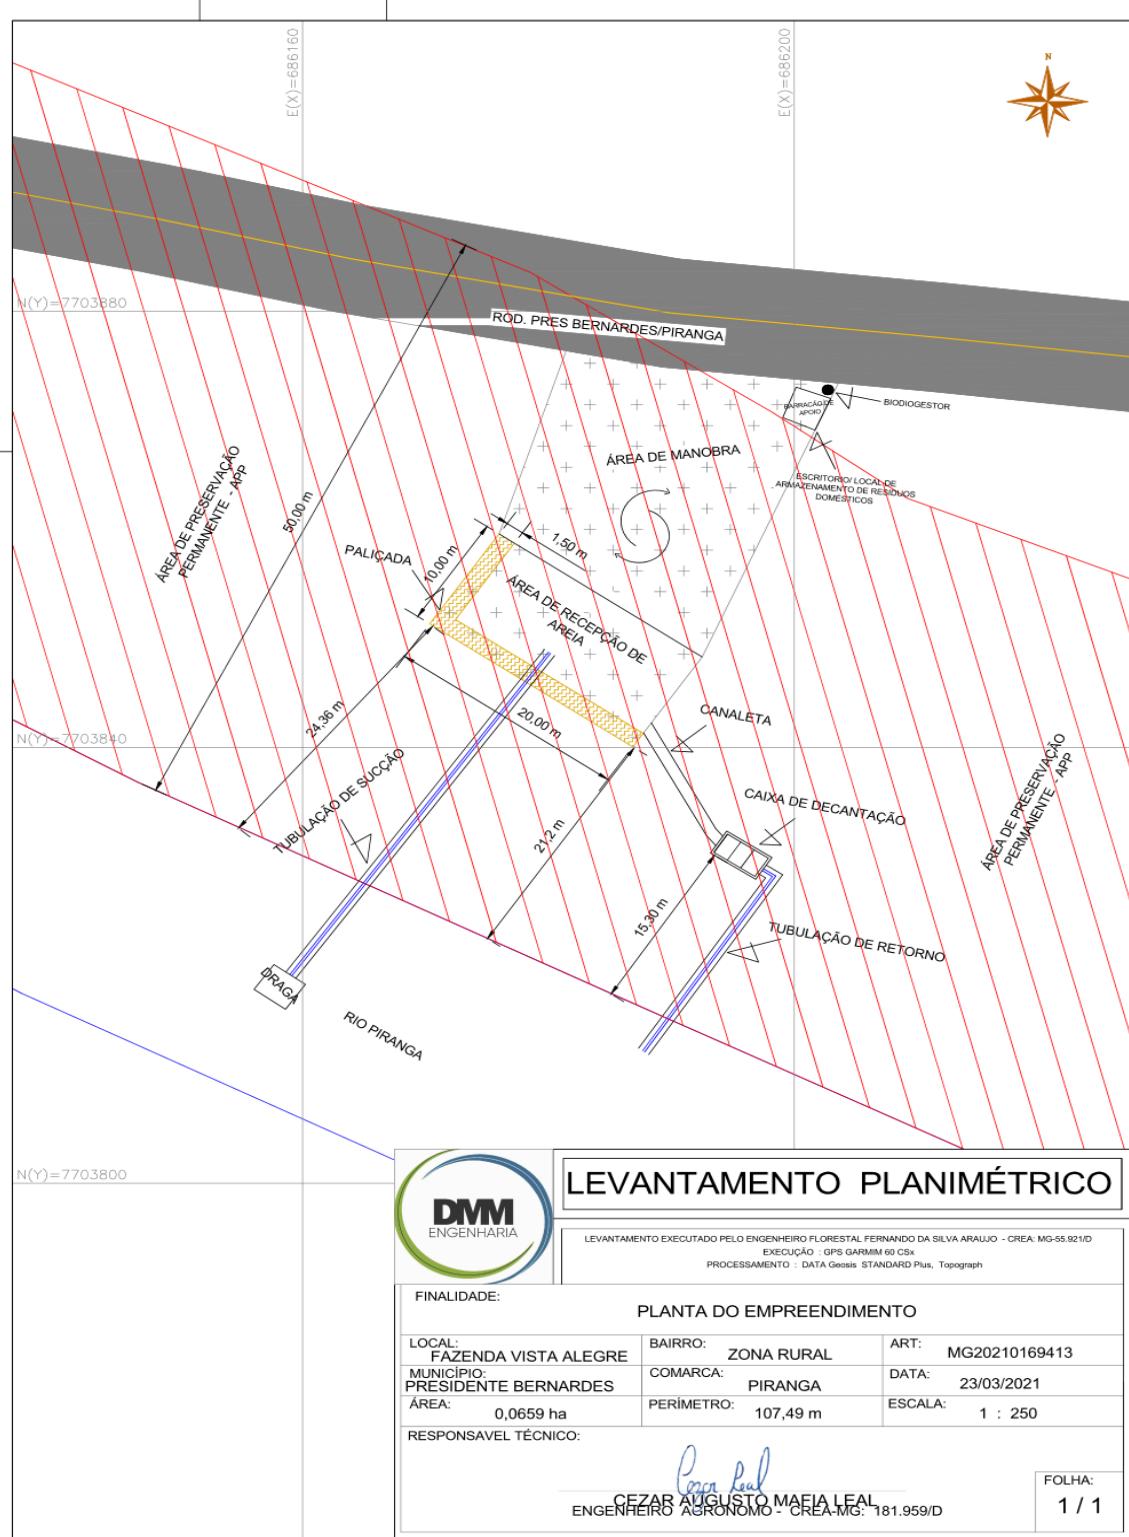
imagem detalhada da planta planimétrica georreferenciada do empreendimento
